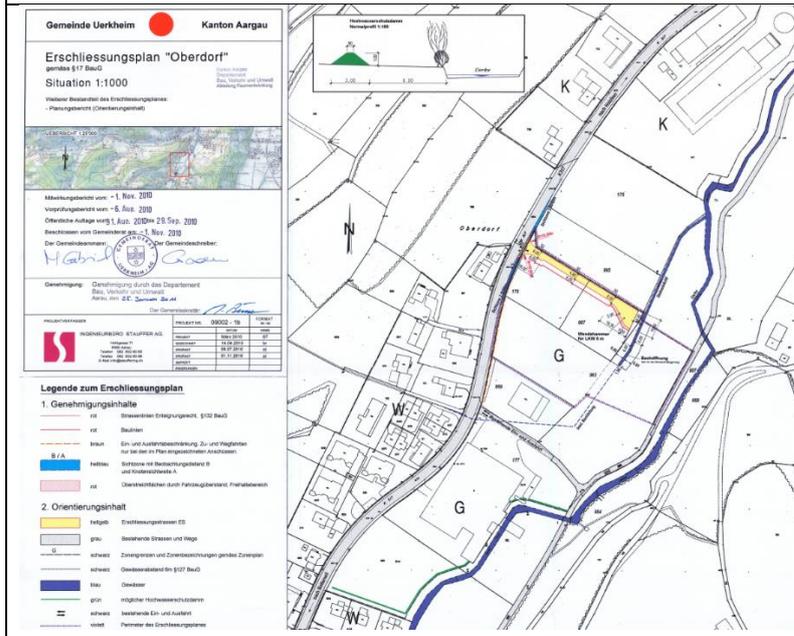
Erschliessungsplan «Oberdorf» aus dem Jahr 2011
